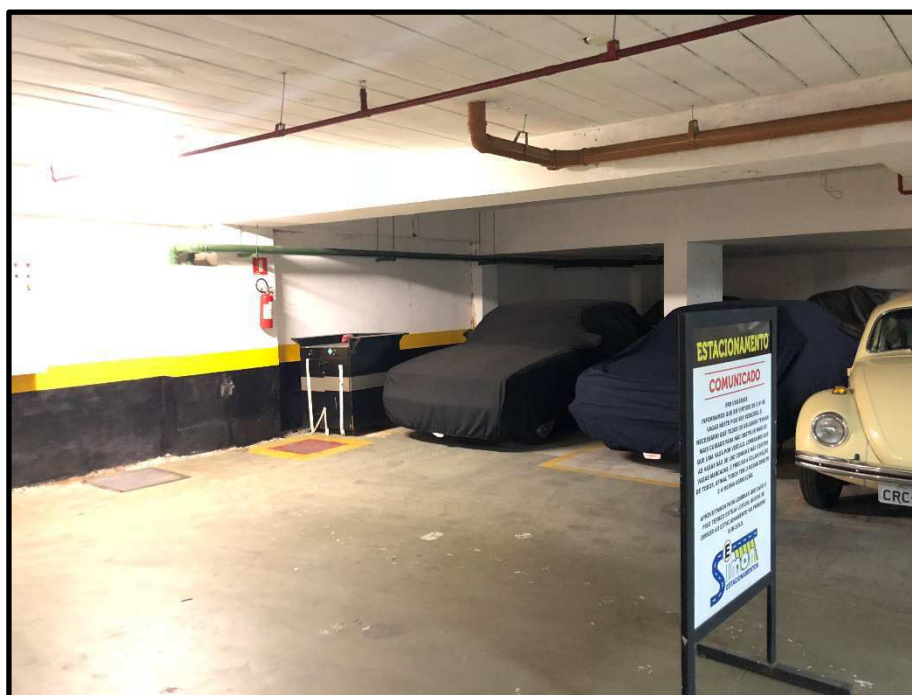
2º subsolo – vagas de garagem – Vista 4
